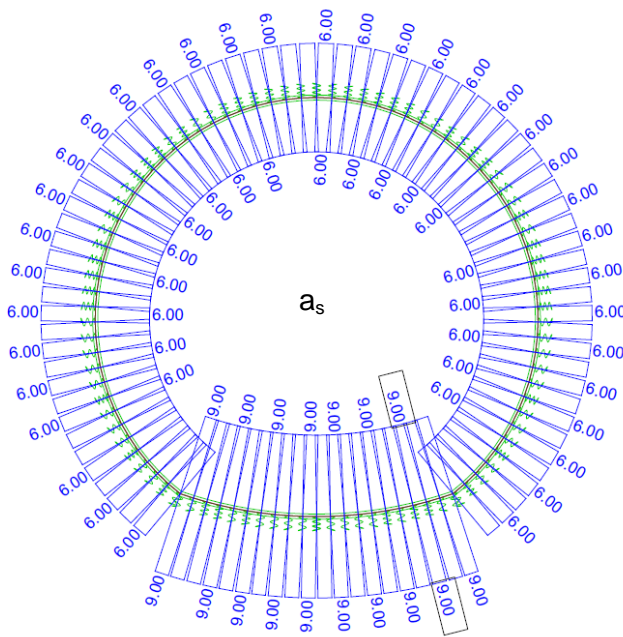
Eisenbahntunnel: Erforderliche Bewehrung a_s [cm^2/m] in Ringrichtung aus Kaltbemessung [cm^2/m]
